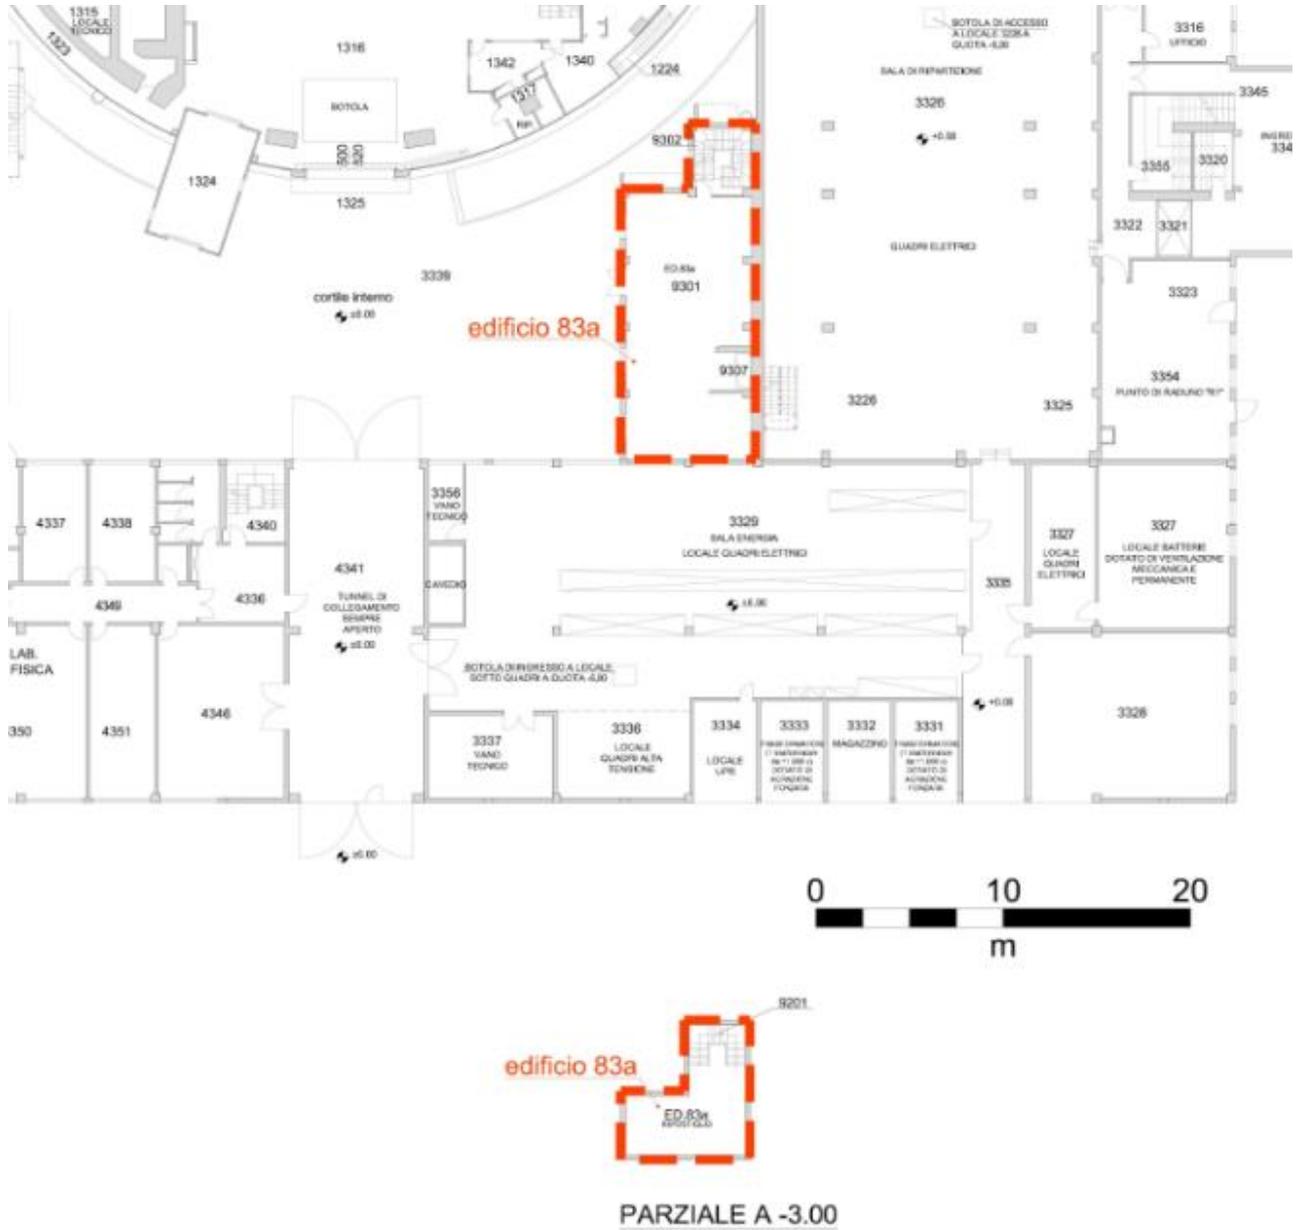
Edificio 83a – Layout -3,00 m e ±0,00 m
